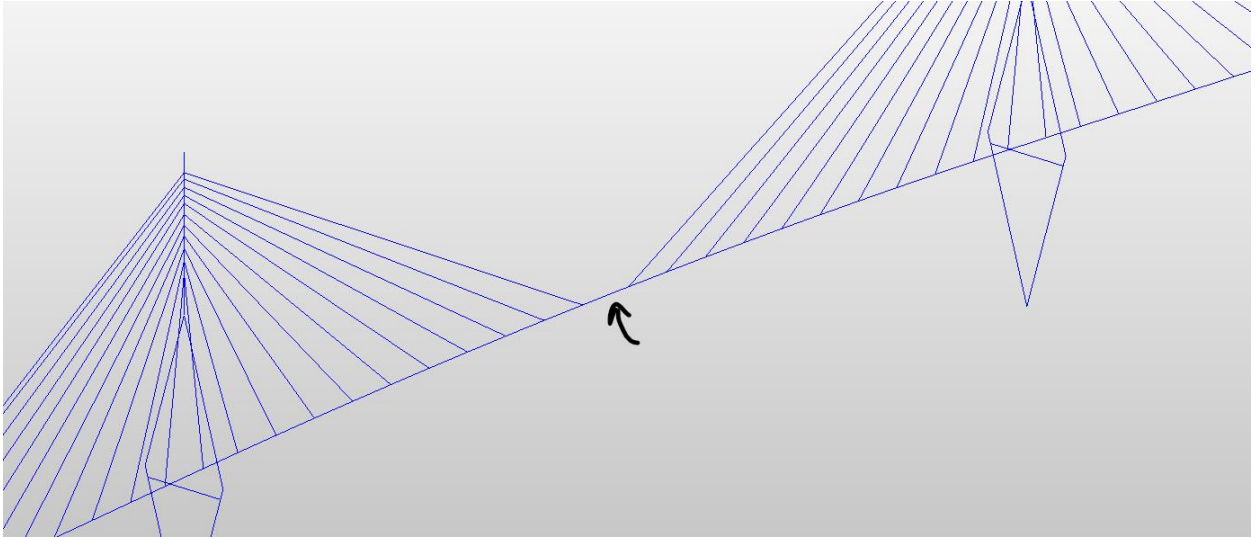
Modelización geométrica tablero viga ortótropa
